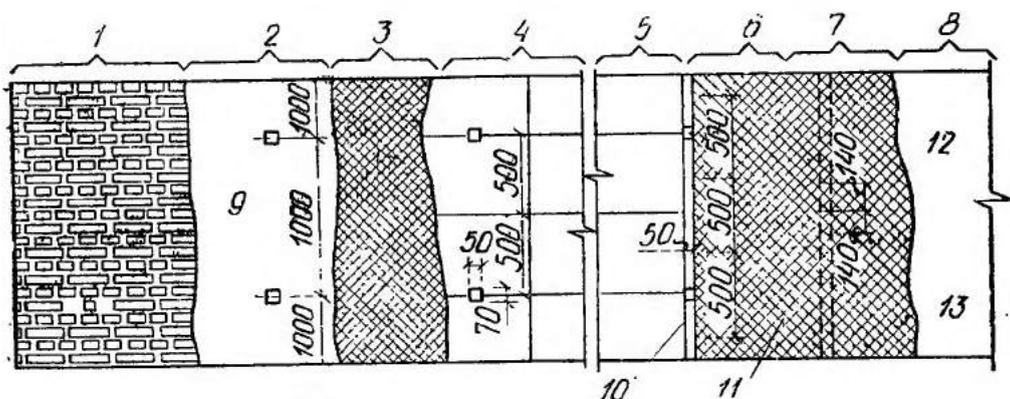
Теплоизоляция кирпичных стен торфоплитами
